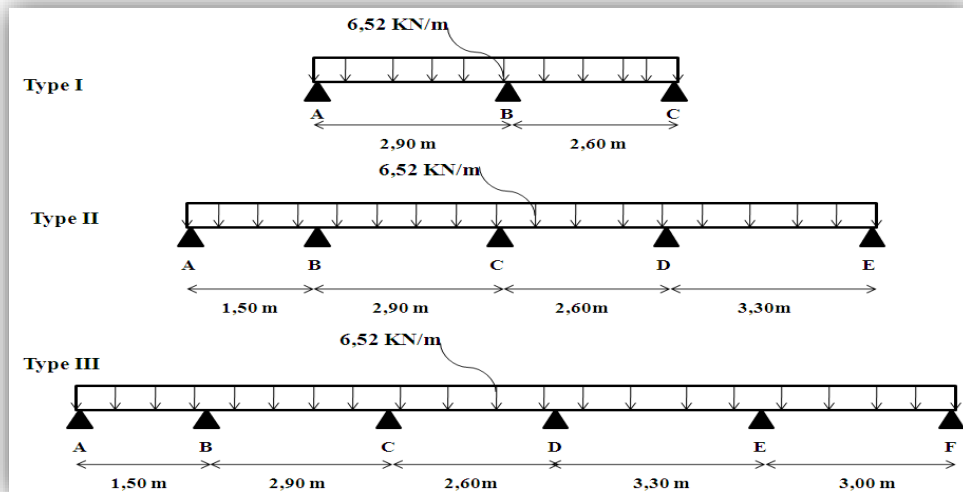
Types des poutrelles de notre structure à L'ELU (Plancher terrasse inaccessible).
